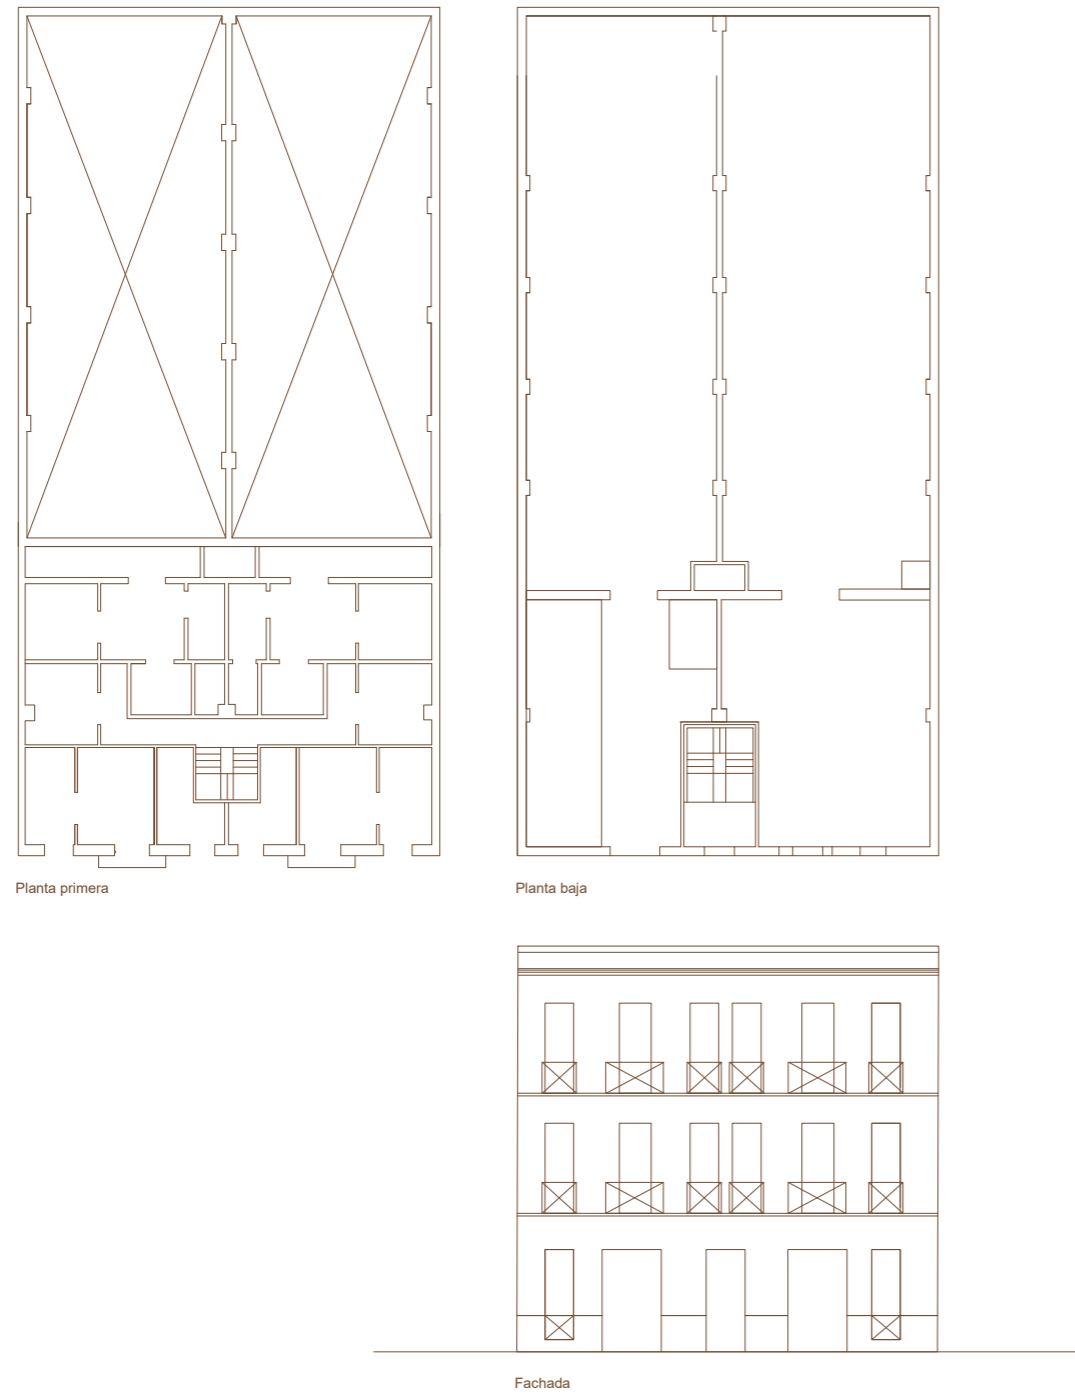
Planos edificio calle Manuel Arnau 11. Arquitecto Demetrio Ribes. Elaboración propia
